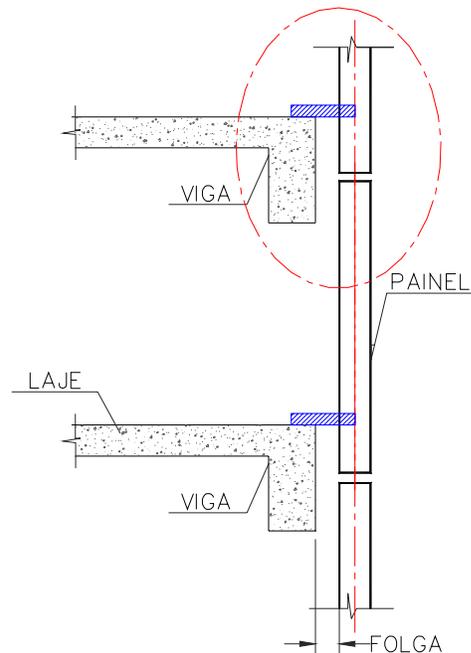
Esquema genérico da fixação dos painéis na estrutura
